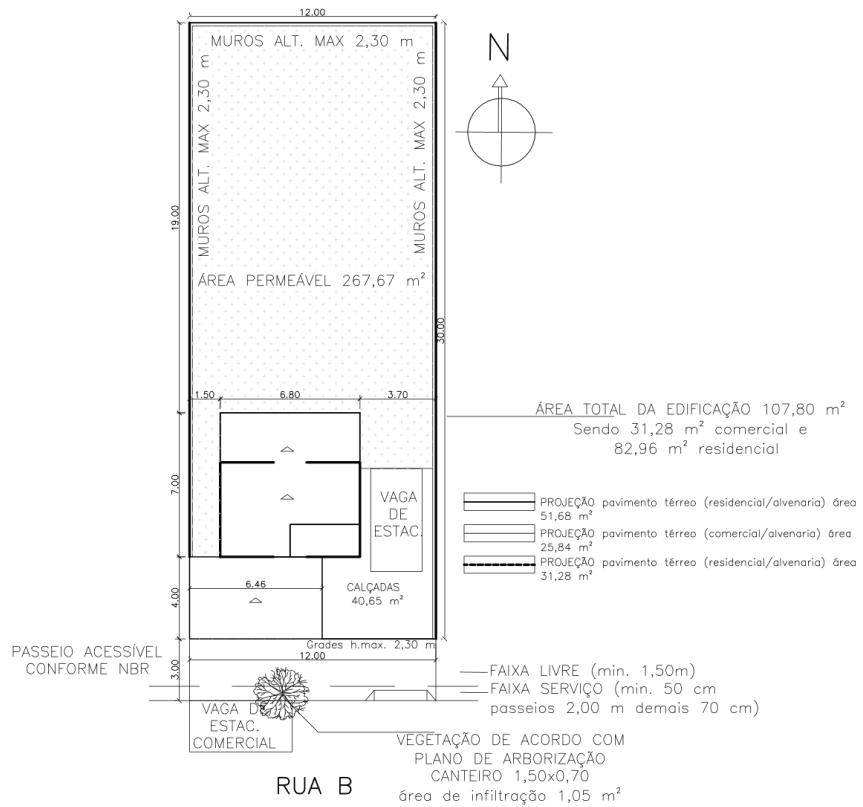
Croqui demonstrativo de projeto de localização – 1 (um) pavimento CONSTRUÇÃO (Projeto A)
